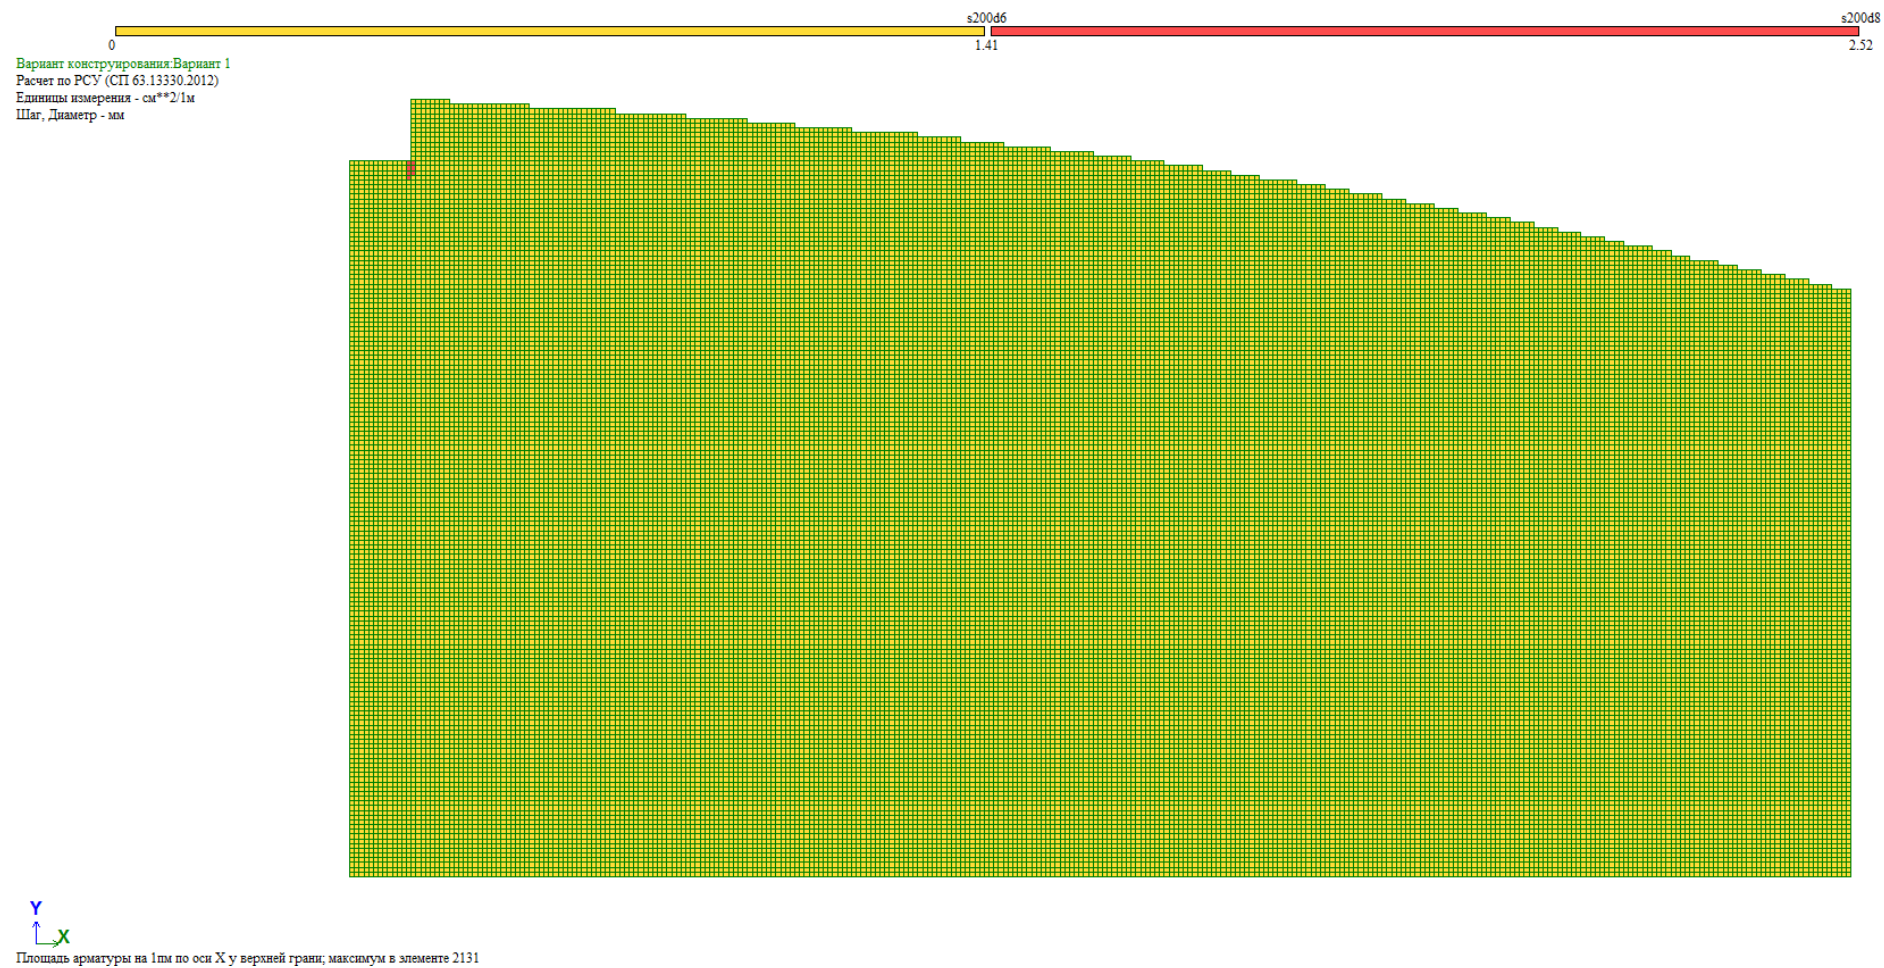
Площадь арматуры по оси X у верхней грани
